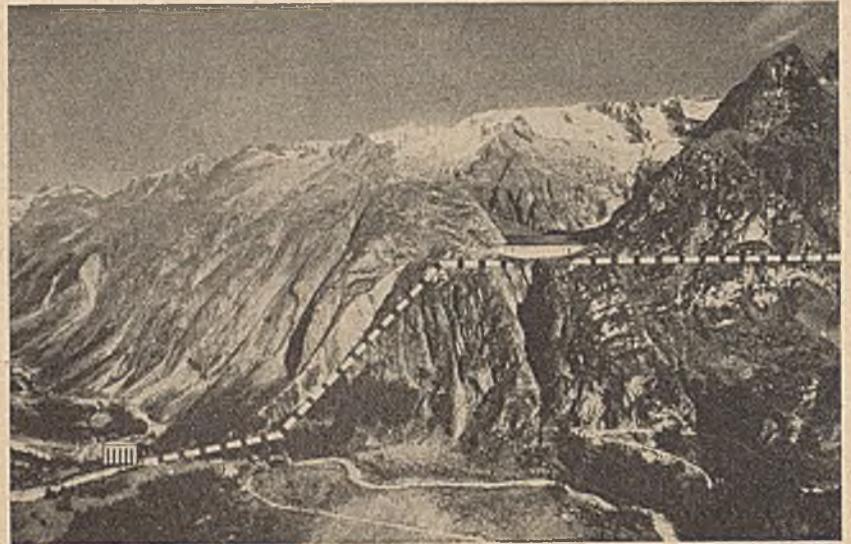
Schematische Darstellung des Verbindungsschachtes Gelmersee—Zentral-Handeck.
